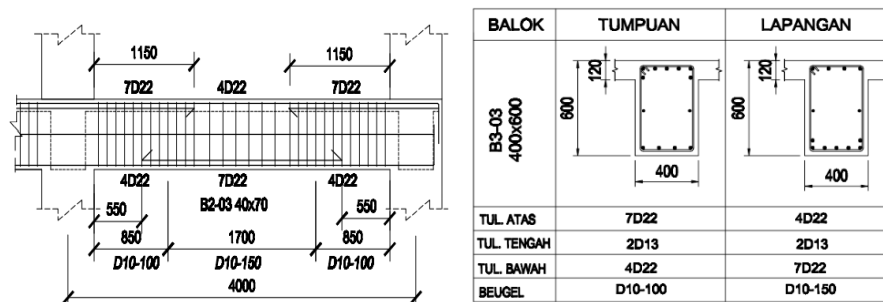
(a) Balok B2 (b) Tulangan Balok B2
